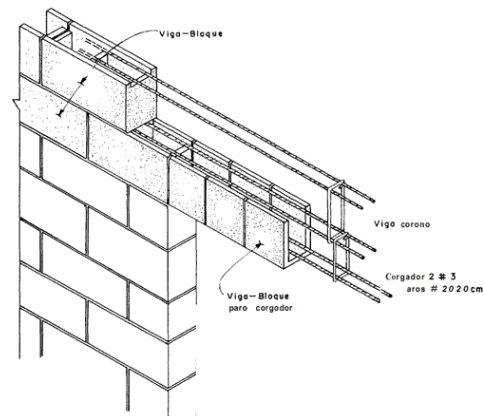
Mure të përforcuara me breze nga betoni i armuar
